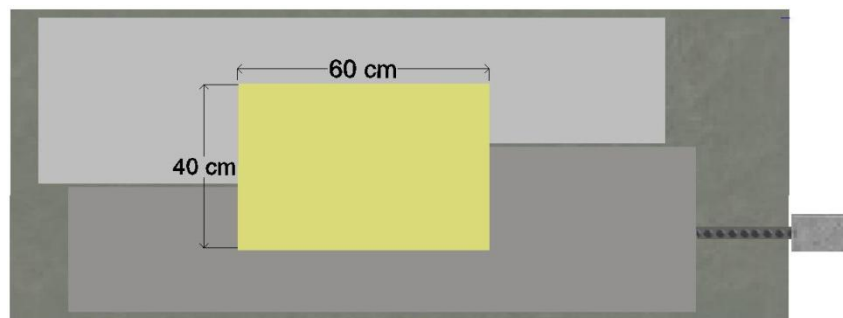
Dimensiones en planta del arreglo de las capas.
